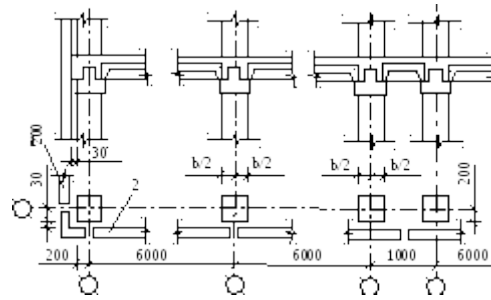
Привязка колонн и наружных стен многоэтажных промзданий с нормативными нагрузками на перекрытия 5...10 кН/м² к продольным и поперечным разбивочным осям и в местах температурных швов. 1 – торцовая стена; 2 – продольная стена.
